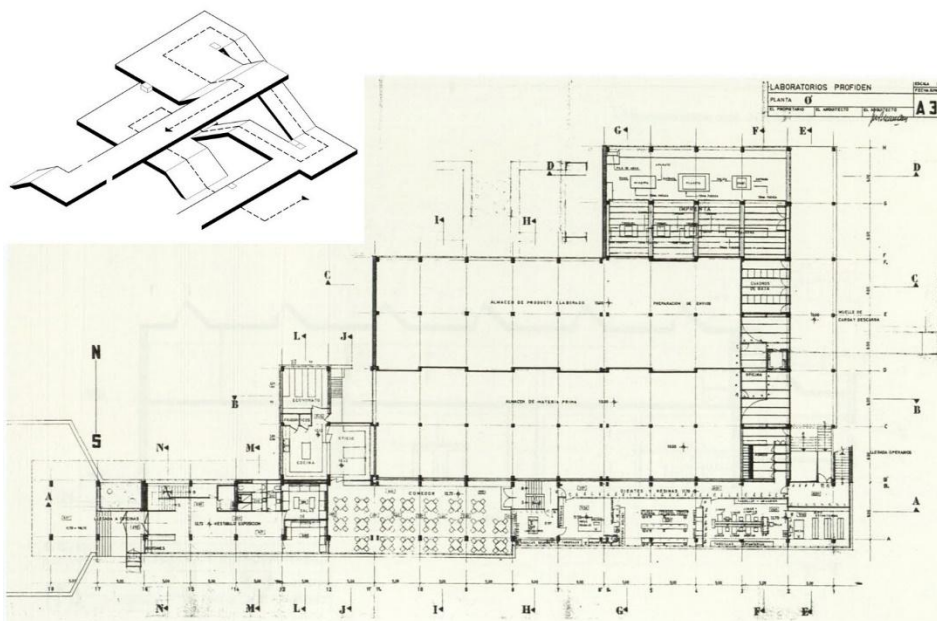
Proyecto realizado, planta nivel 0' (entrada principal) (Baldellou 1998: 4). Arriba, esquema de escalera semiexterior (autor).
